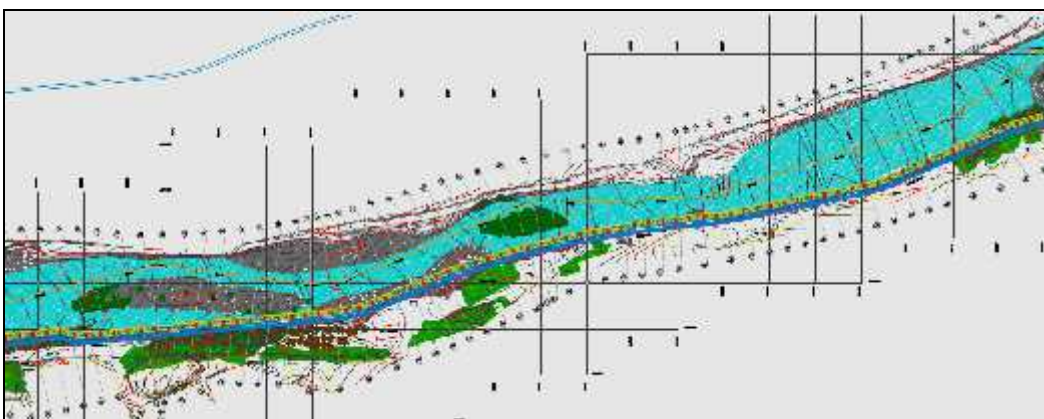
Vista en planta de la línea del thalweg - 1+780 @ 2+940.
